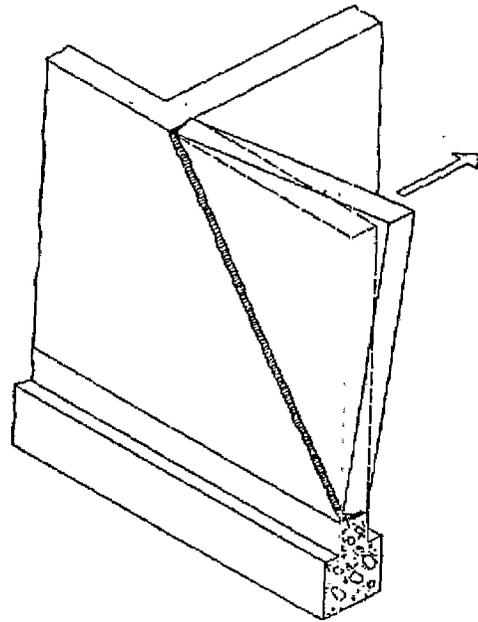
b.-FALLA TIPICA EN FLEXION DE MURO SIN ARRIOSTRAMIENTO EN DOS BORDES.
